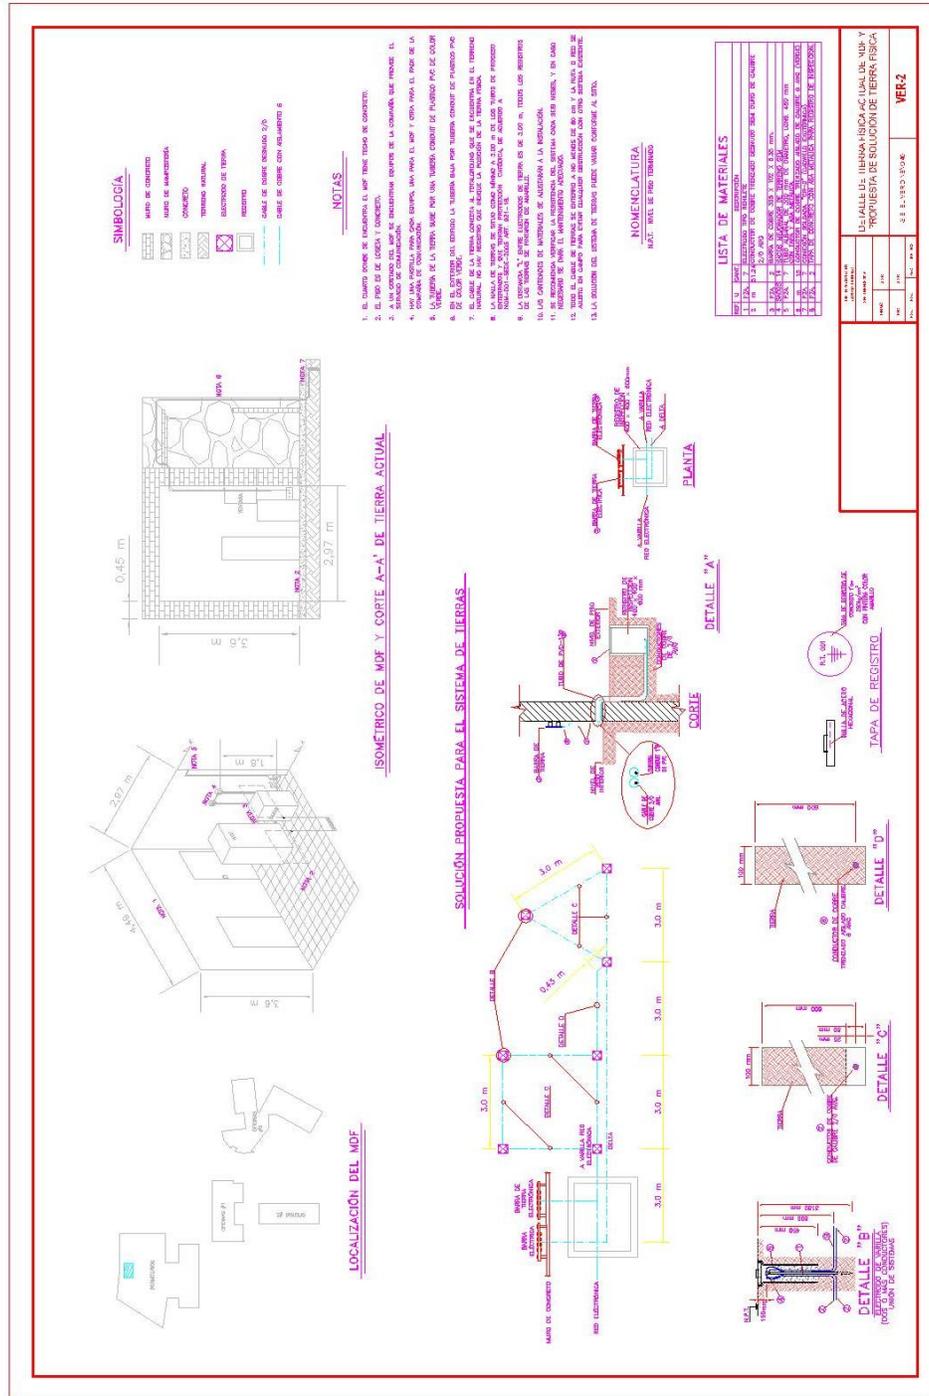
Plano isométrico de MDF y propuesta de solución de tierra en sistema delta de las oficinas de El Verdineño (fuente: plano armado por el autor con la figura 3.26).
